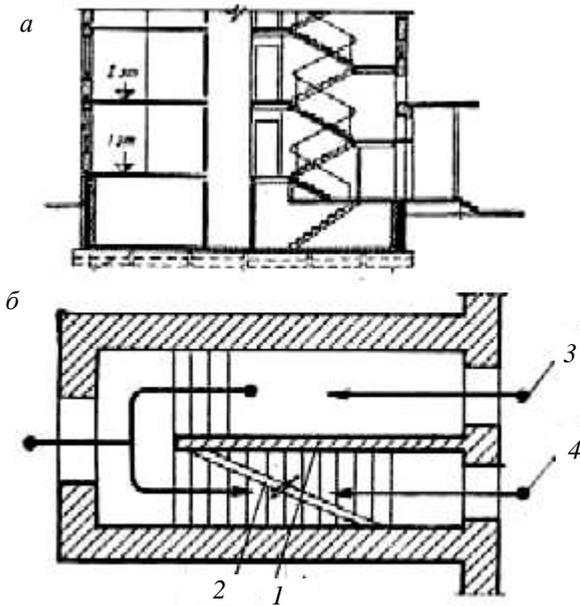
Обособленный вход в подвал: *а* — разрез; *б* — план;
